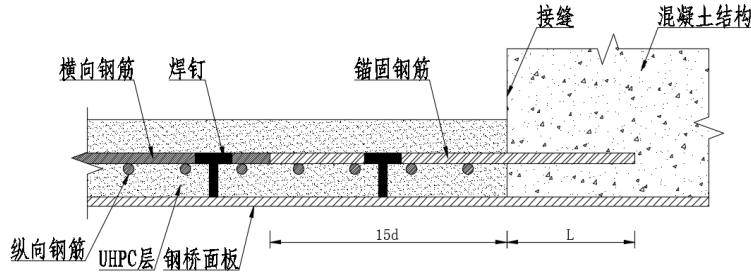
UHPC 层与混凝土结构连接立面示意图
